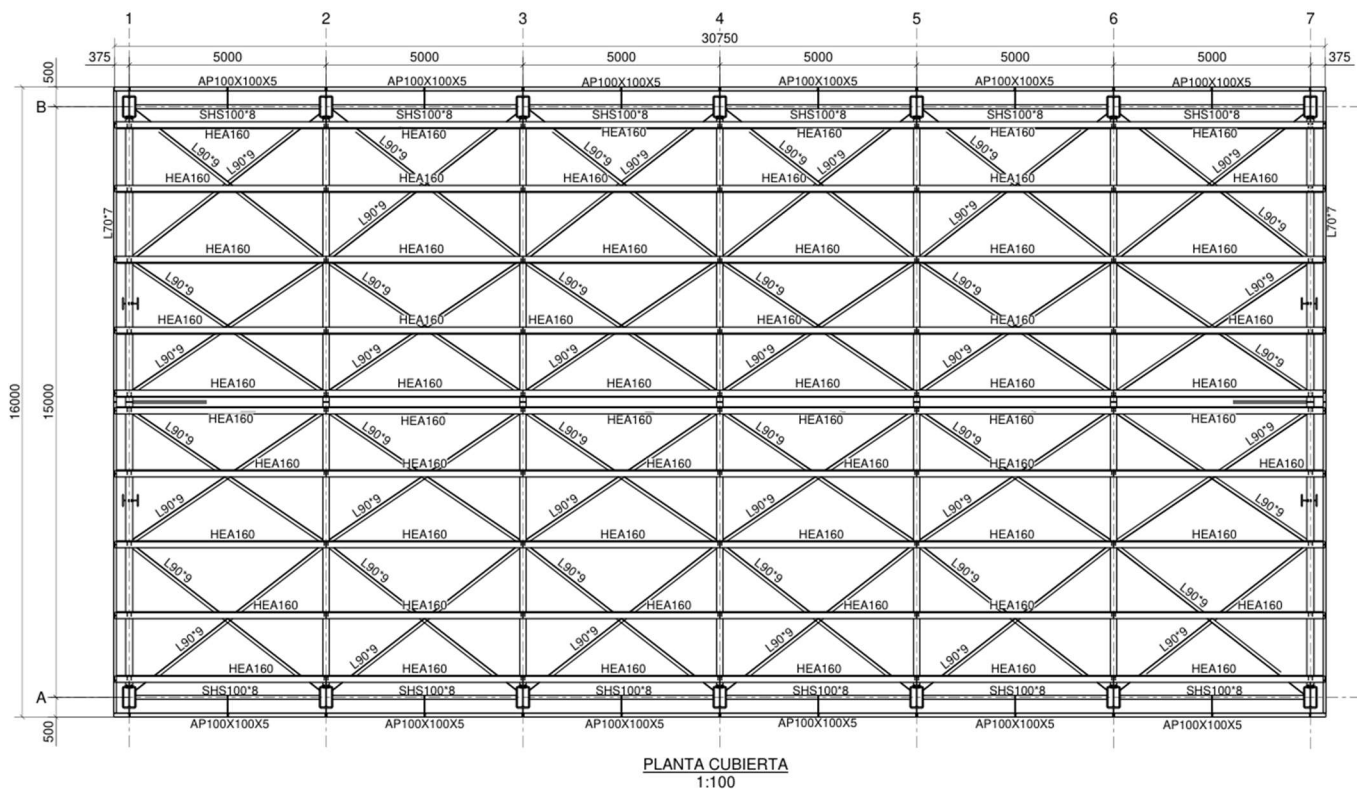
Planta cubierta Nave Metálica grupo 1.
